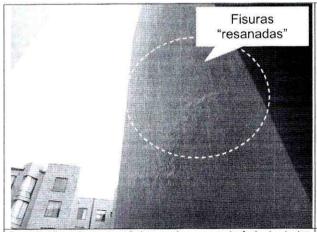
Vista de "resanes" tipo, en los muros de fachada de las edificaciones evaluadas.
